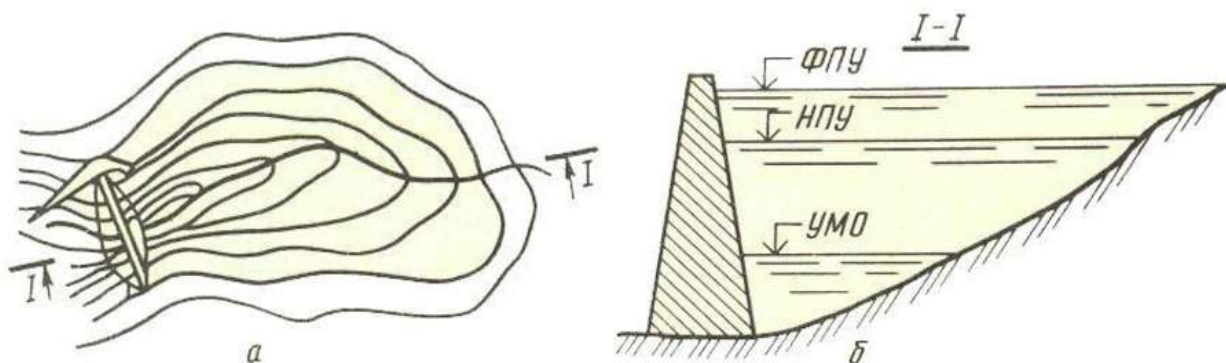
План (а) и продольный профиль (б) водохранилищ
